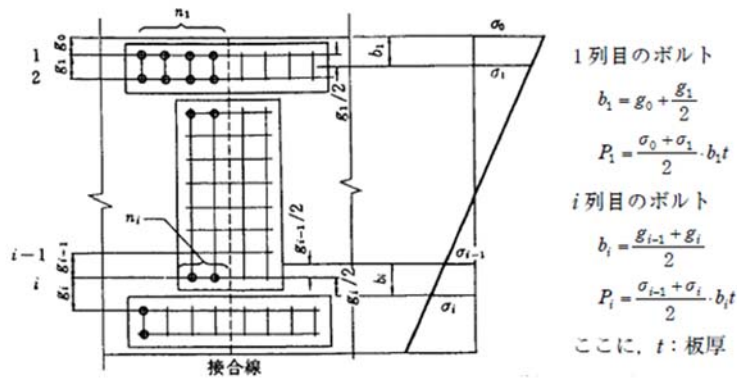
ボルトに作用する力 (垂直応力の分布が均等でない場合)
